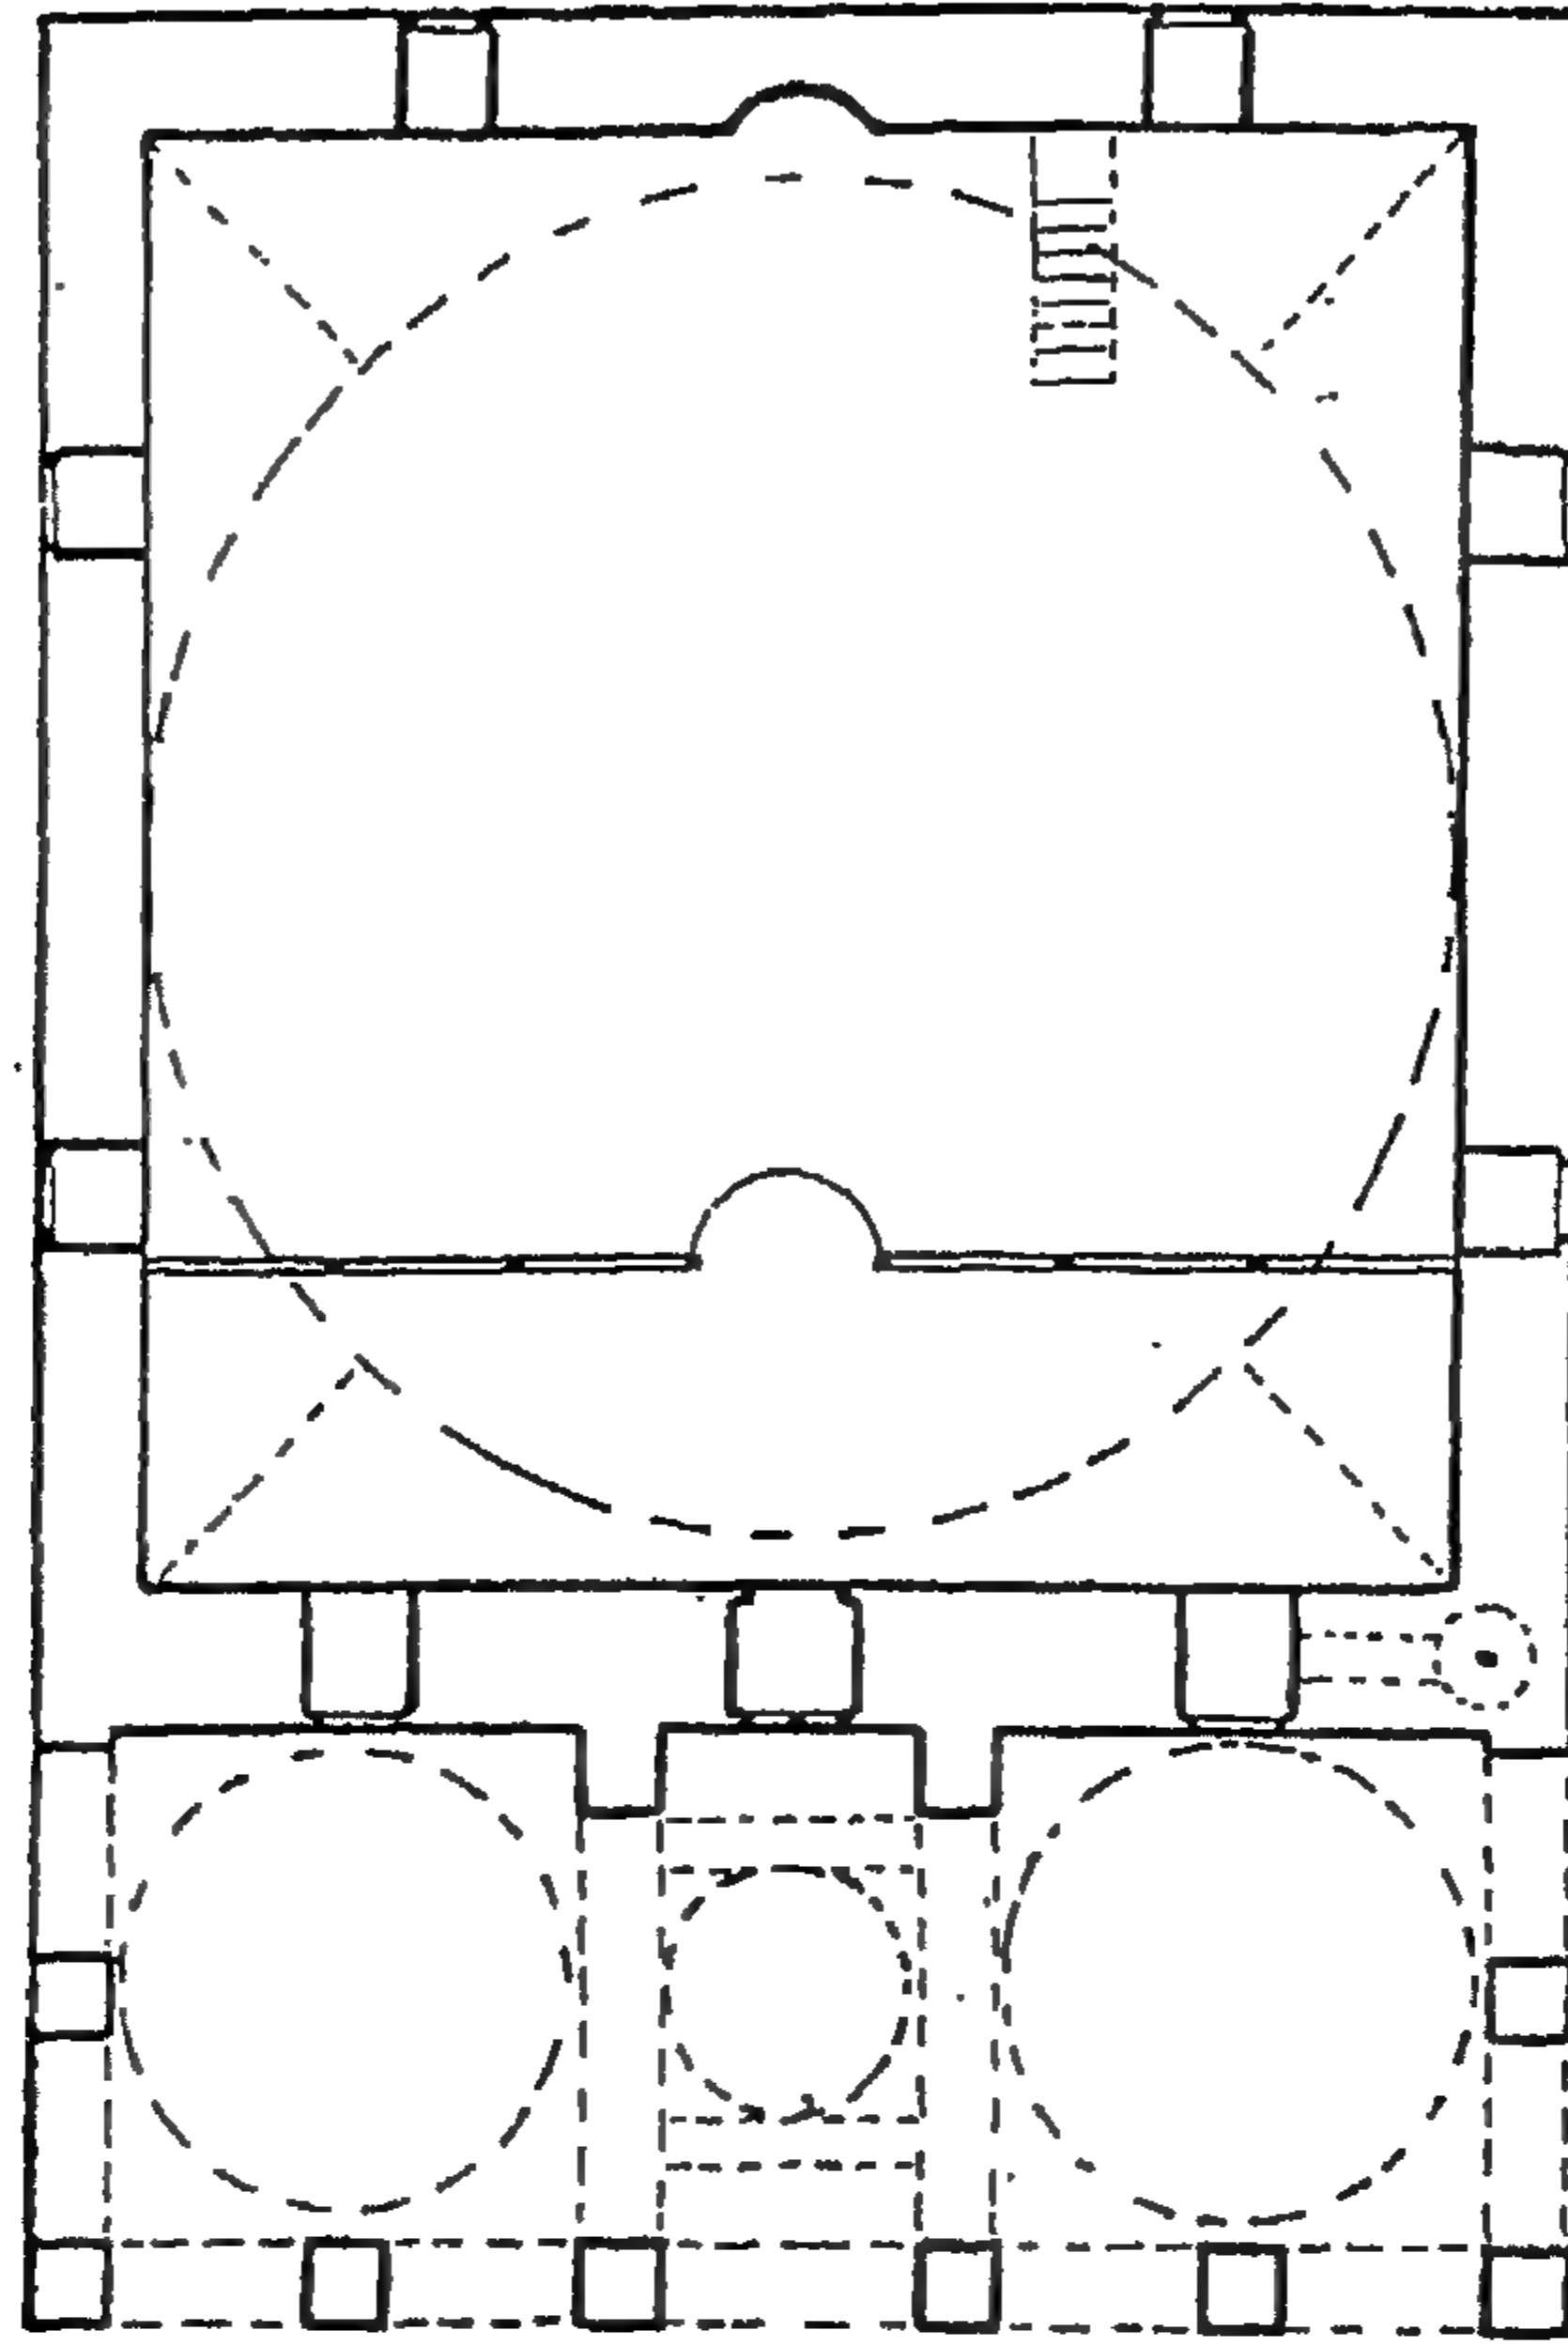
مسقط أفقي لمسجد قاسم باشا في ادرنه . (عن : Kuran) .
